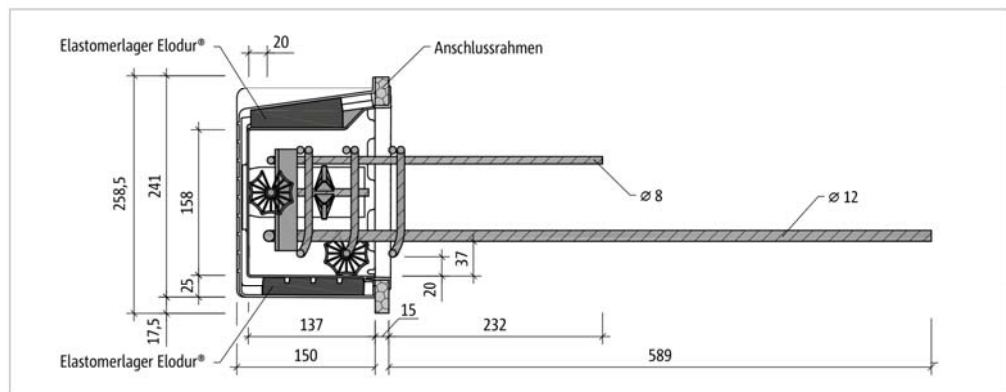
Schöck Tronsole® Typ Z-V+V-T beziehungsweise Typ Z-VH+VH-T: Vertikalschnitt
